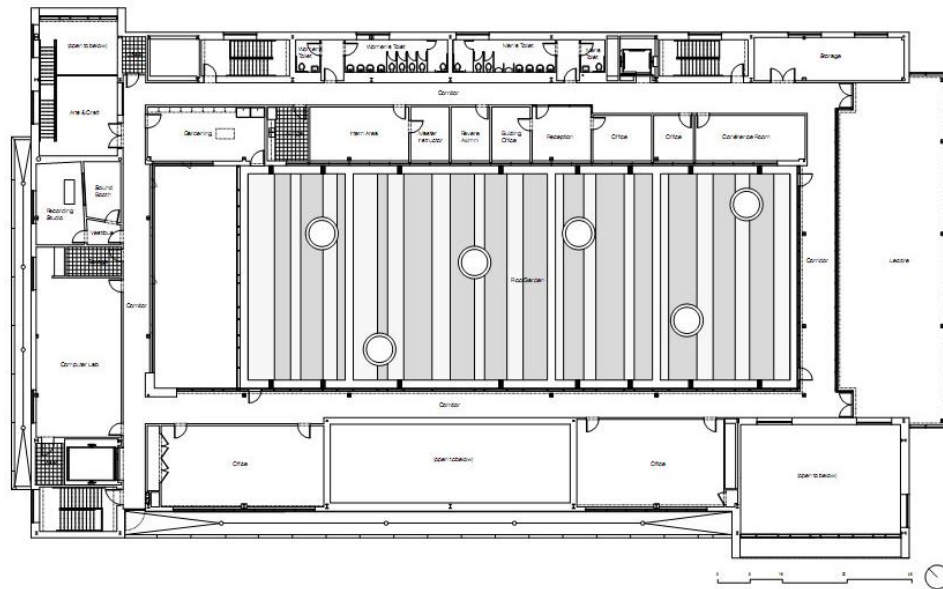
17 Site Plan Garry Comer Youth Center
